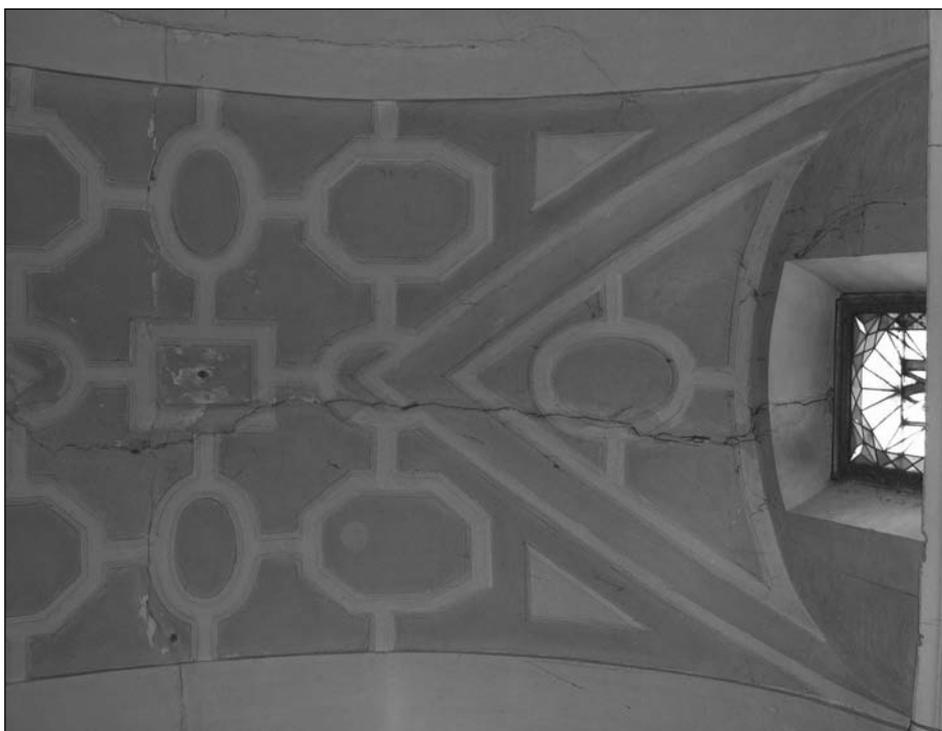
Detalle de la bóveda del segundo tramo de la nave
